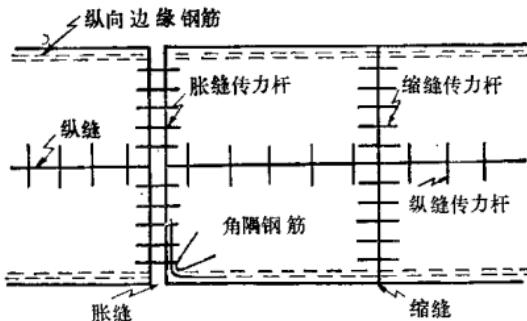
路面板内传力杆及边角钢筋平面布置示意图
